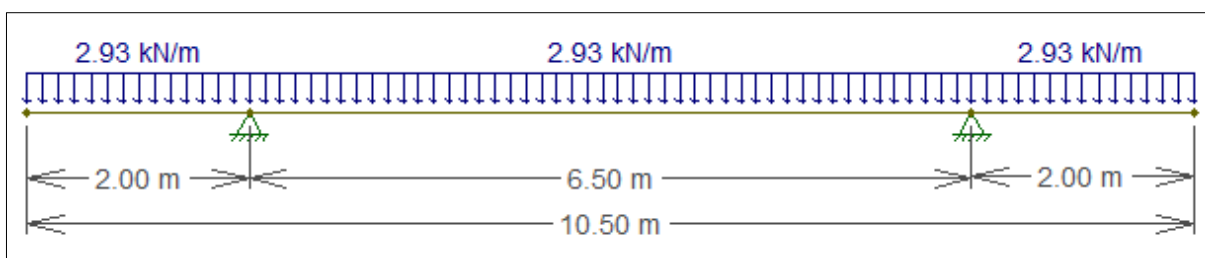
Sistema Estrutural referente ao içamento das vigas
